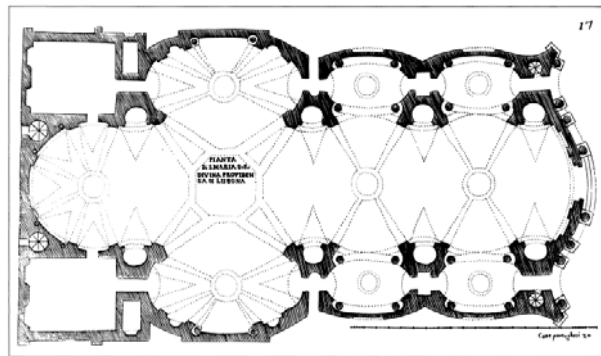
Grundriss S. Maria della Divina Provvidenza
